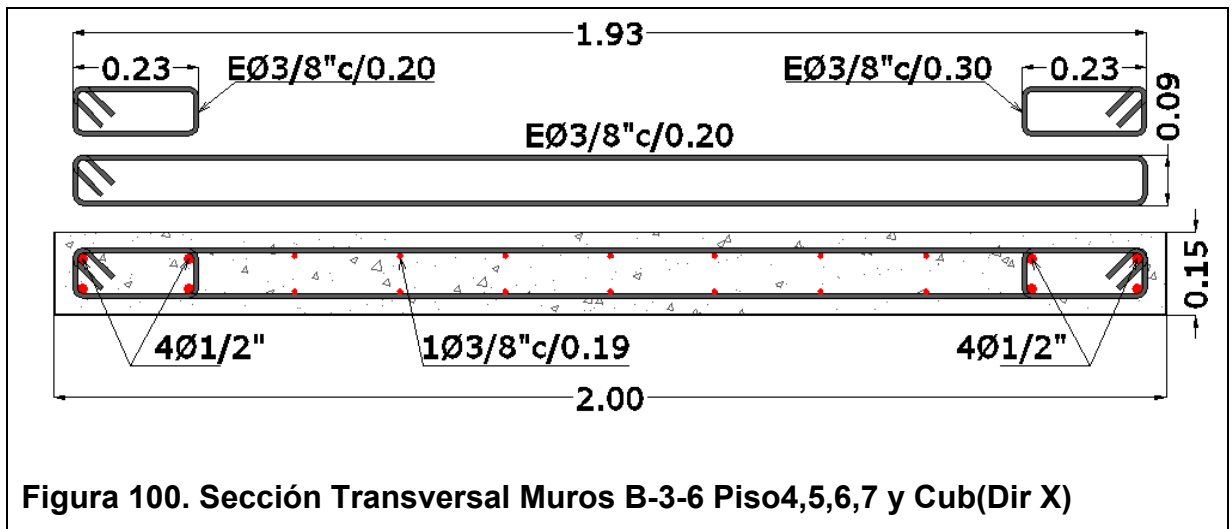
Sección Transversal Muros B-3-6 Piso4,5,6,7 y Cub(Dir X)
